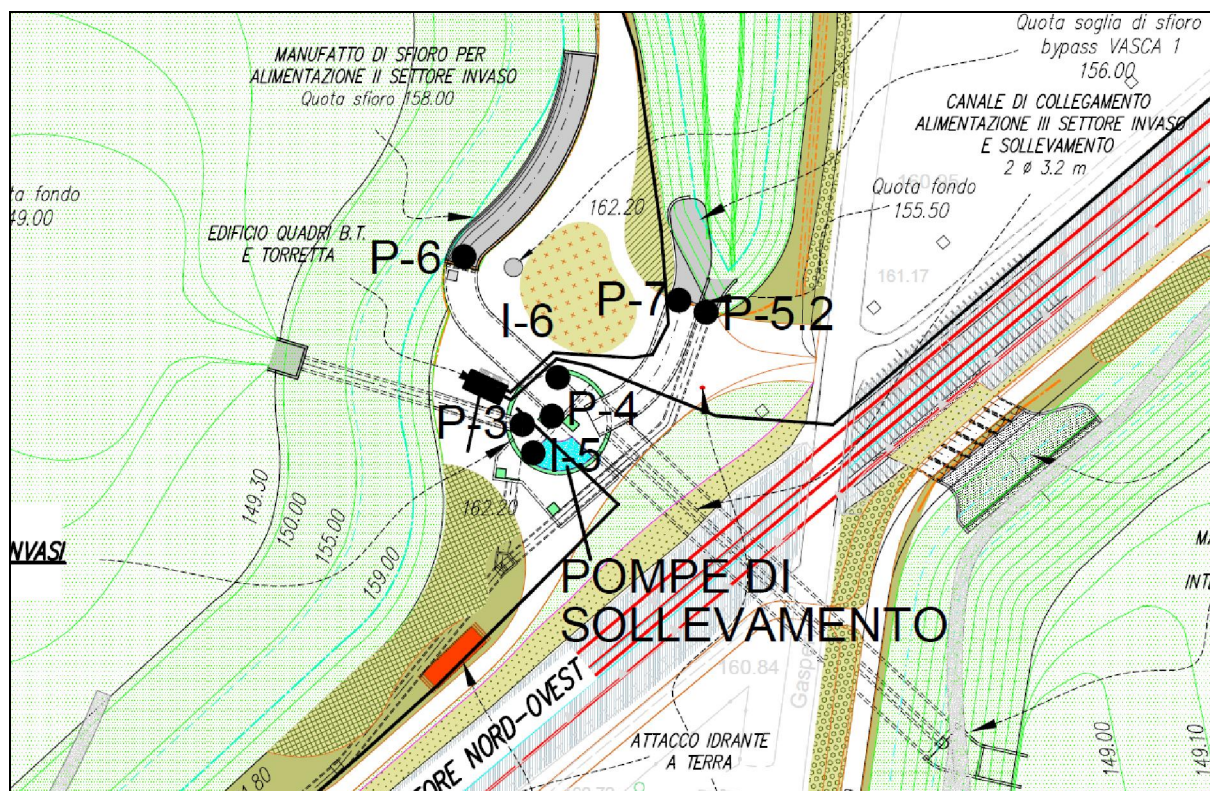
Stralcio planimetrico con l'ubicazione delle paratoie "P".
